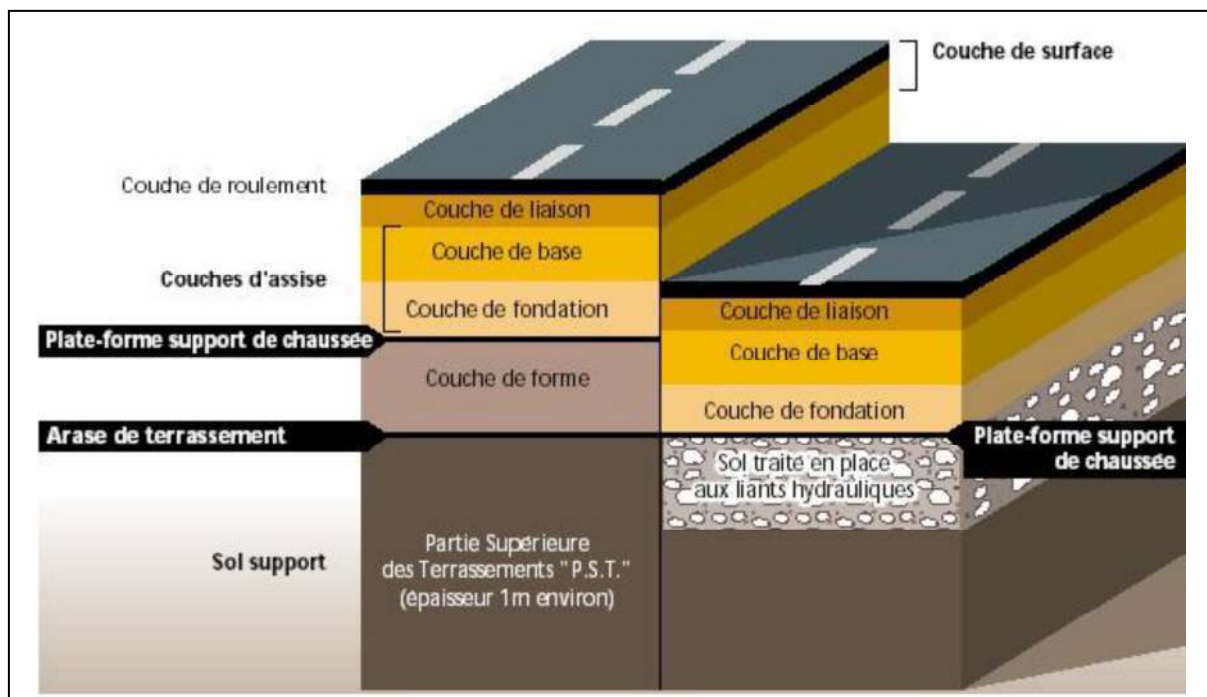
les différentes couches qui constituent la structure de la chaussée
